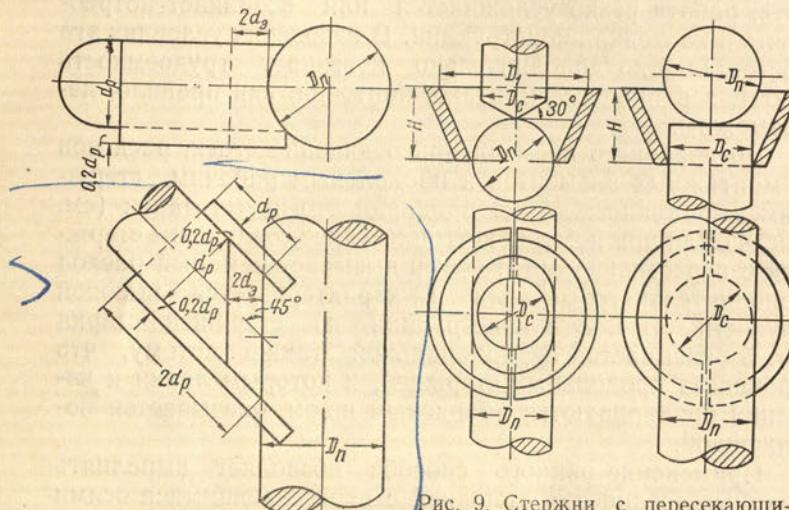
Стержни с осями, пересекающимися под углом 45°, подготовленные к ванной сварке (слева — привариваемый стержень расположен над основным стержнем, справа — под ним)
